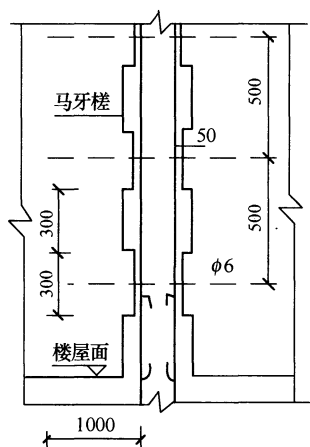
拉结钢筋布置及马牙槎示意
